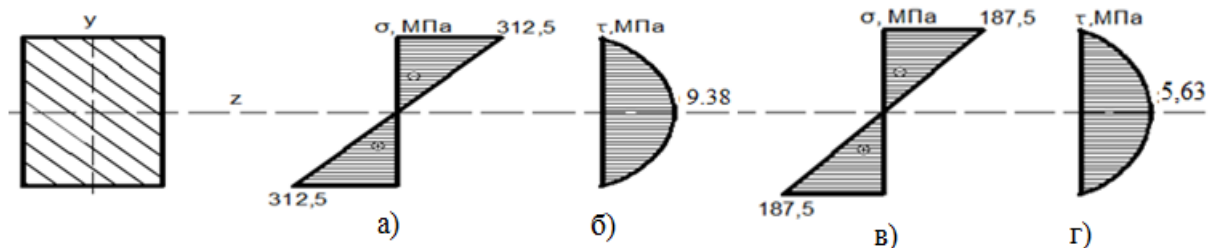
Эпюры нормальных σ и касательных τ напряжений балки, армированной АСП соответственно (а, б) , МПа; в, г – эпюры нормальных σ и касательных τ напряжений балки, армированной стальной арматурой соответственно, МПа
